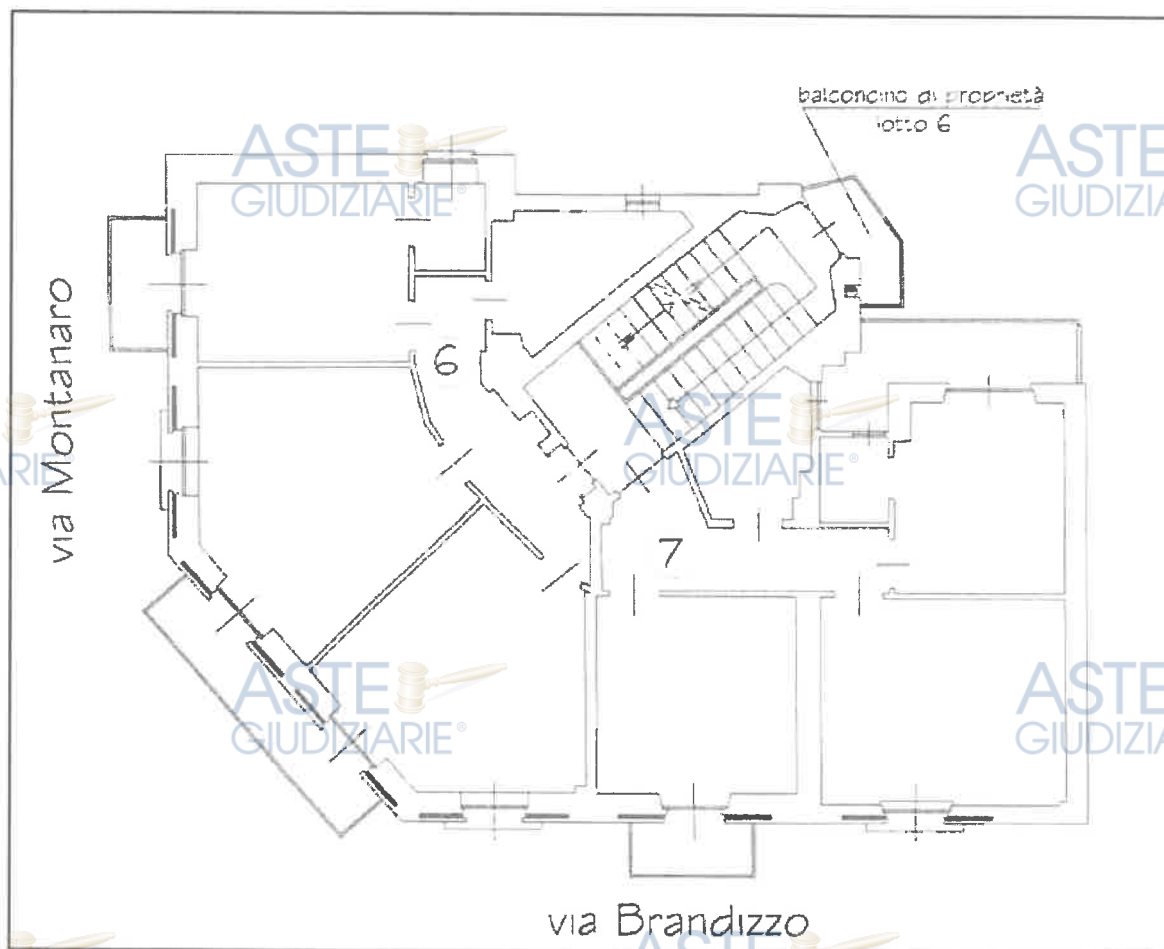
estratto planimetria piano secondo allegato al regolamento condominiale
